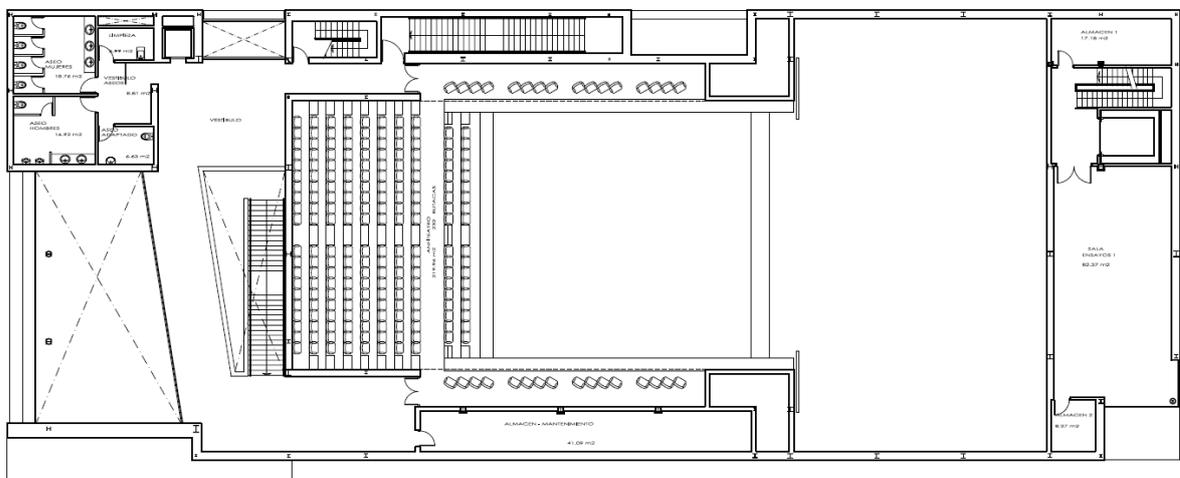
Planta primera (Magín Ruíz de Albornoz)
